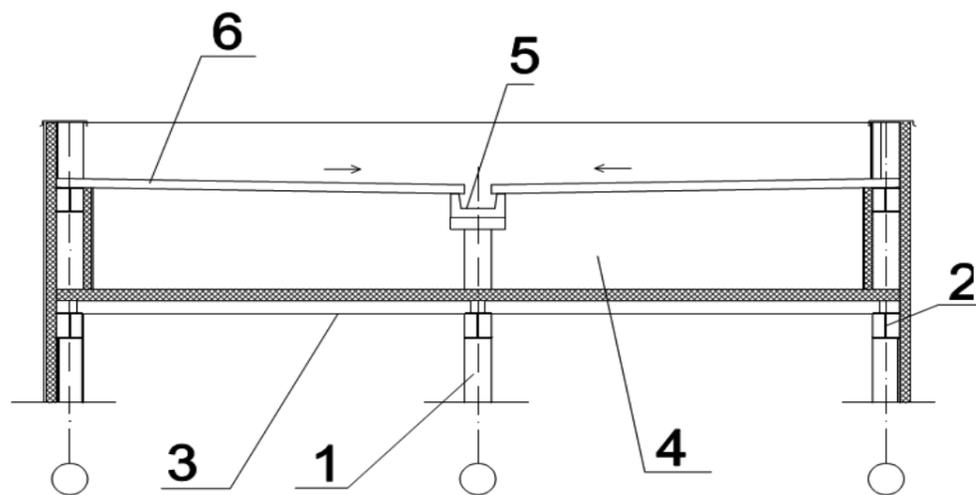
Схема кровли с внутренним водоотводом, с использованием профилированного стального настила. 1-колонна, 2-ригель, 3-плита перекрытия, 4- технический этаж, 5- железобетонный лоток, 6- профилированный настил
